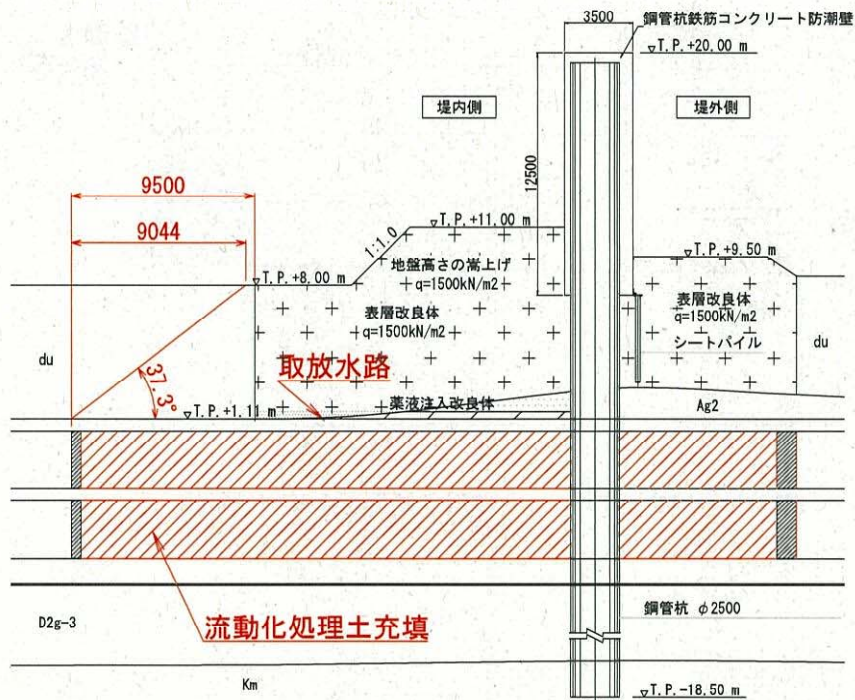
取放水路埋戻し位置断面図 (B-B 断面)
